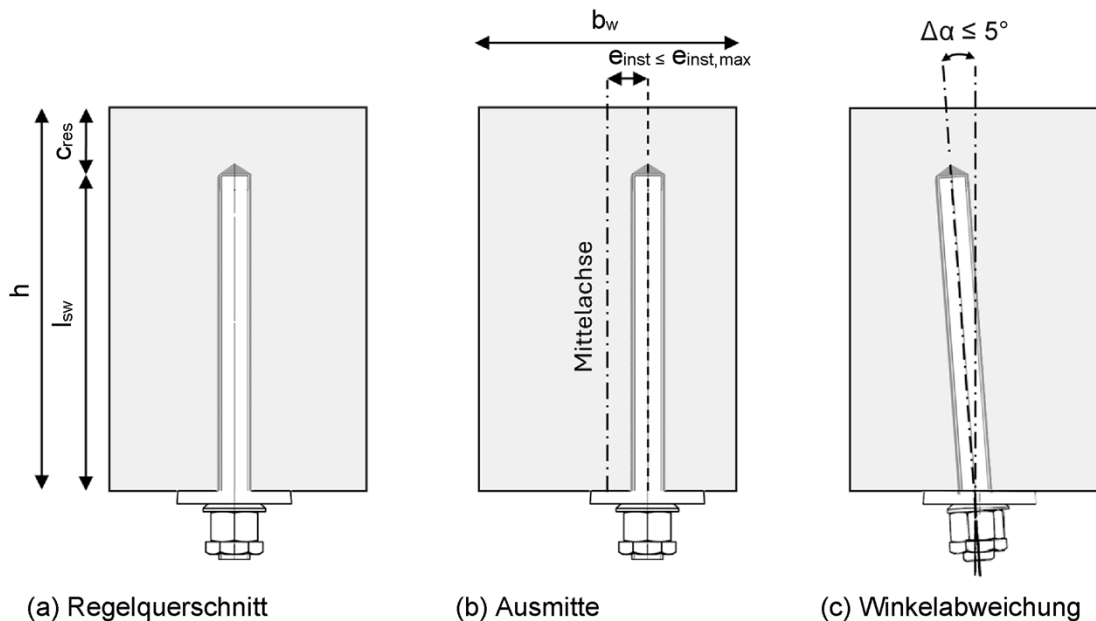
Einbaubedingungen mit Abmessungen und zulässigen Einbautoleranzen, wobei:
